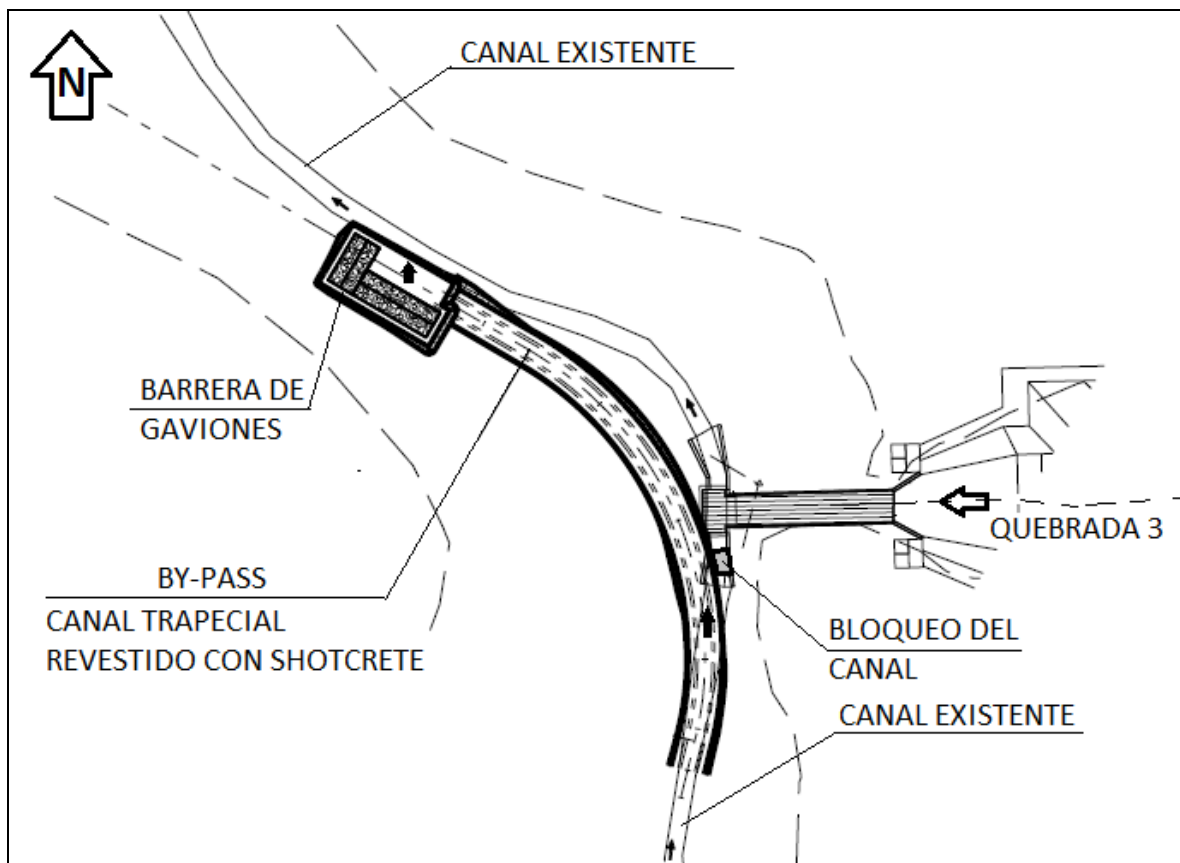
By-pass de canal en Obra de Arte N°3 – Canal Norte Superior
